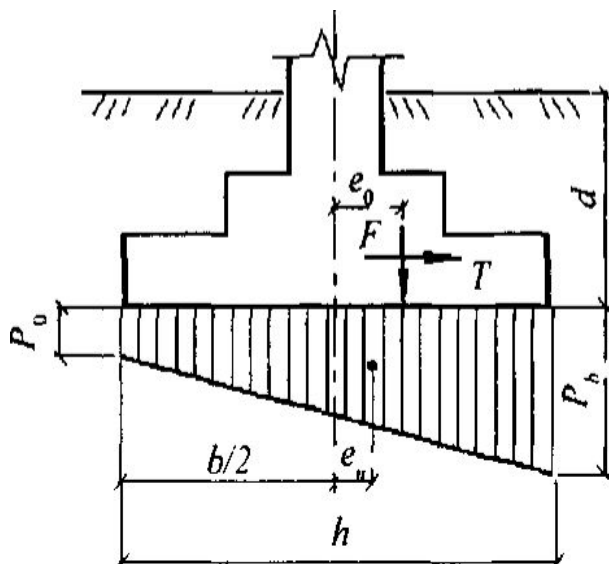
Эпюра предельного давления под подошвой фундамента при сейсмическом воздействии
